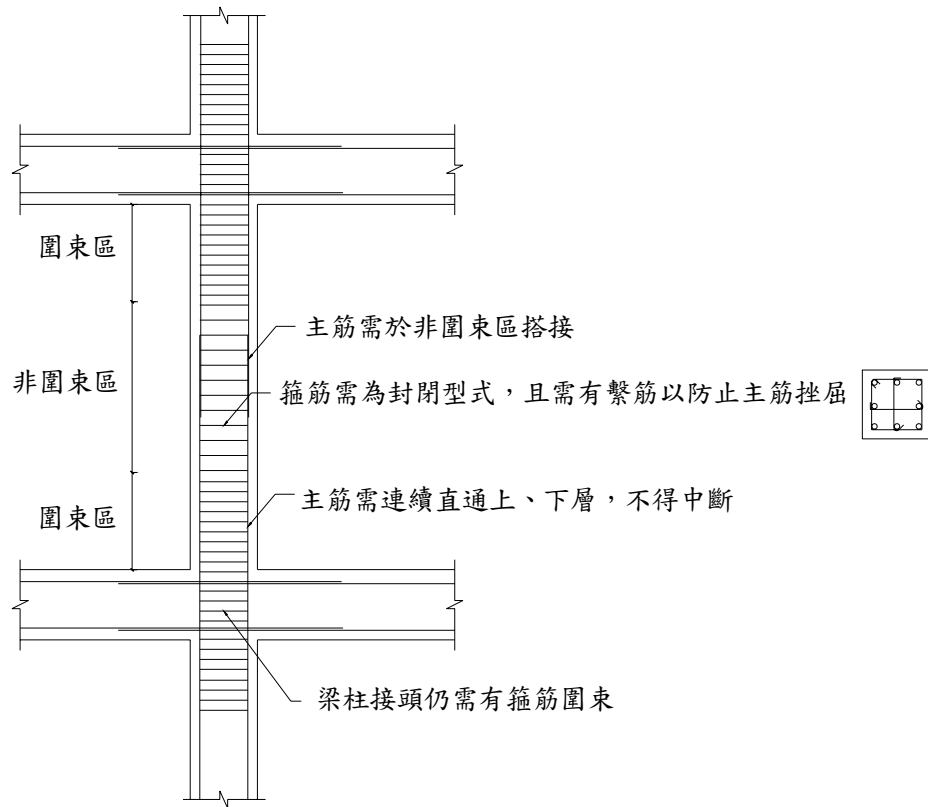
鋼筋混凝土柱鋼筋配置細節需求
